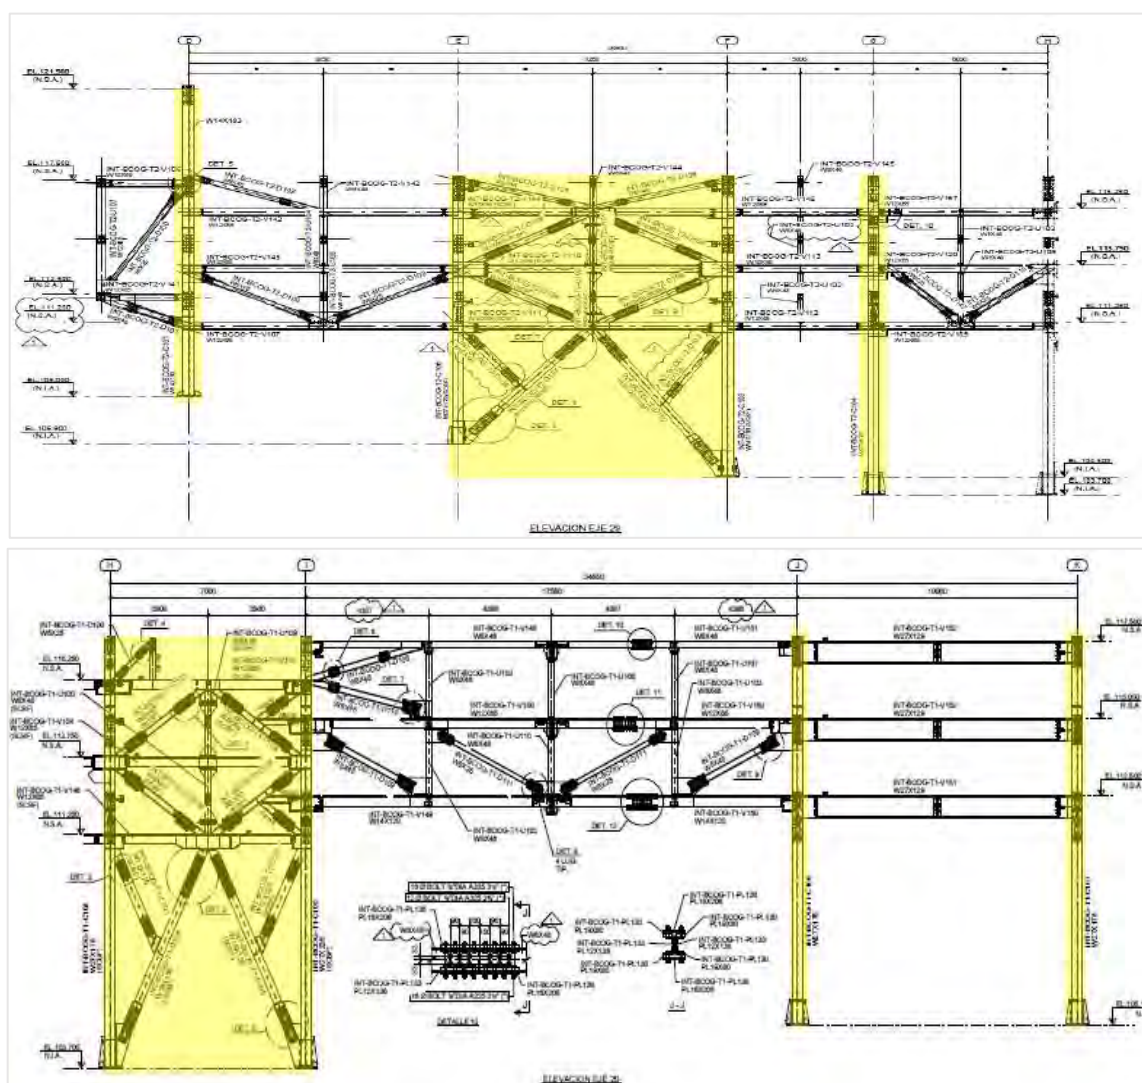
Vista de alzado del *rack* BT-CG, tramos 01 y 02, ejes D-K
